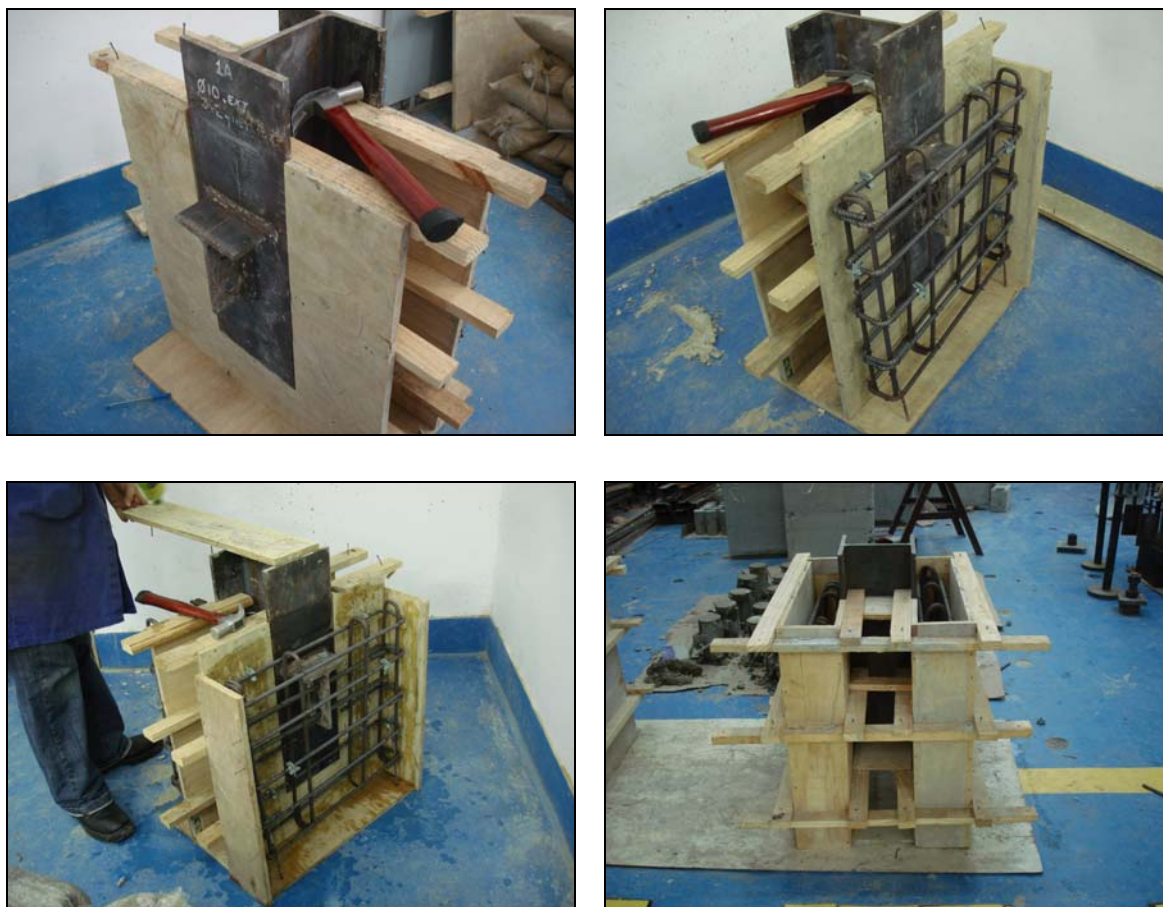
Montagem das formas e armaduras no LEM, PUC-Rio.
